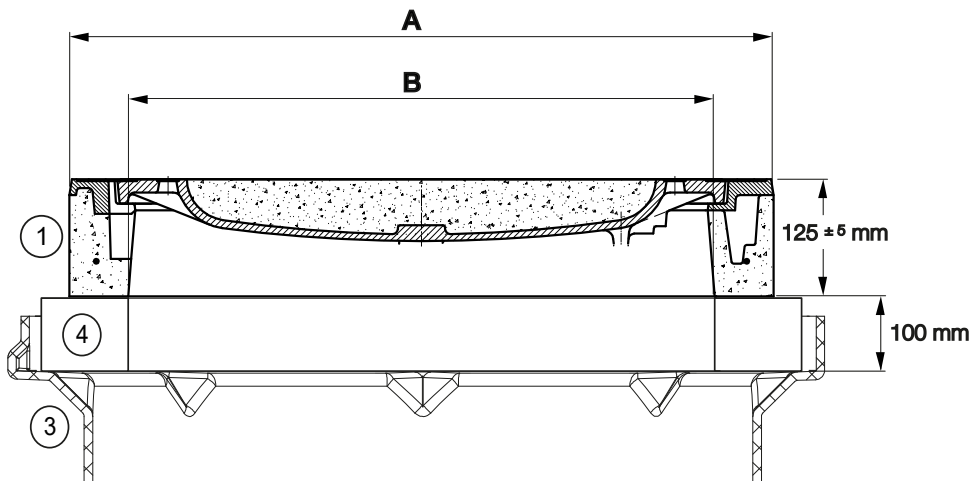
Couvercle de classe B125 monté sur la réserve - schéma de section transversale et dimensions
